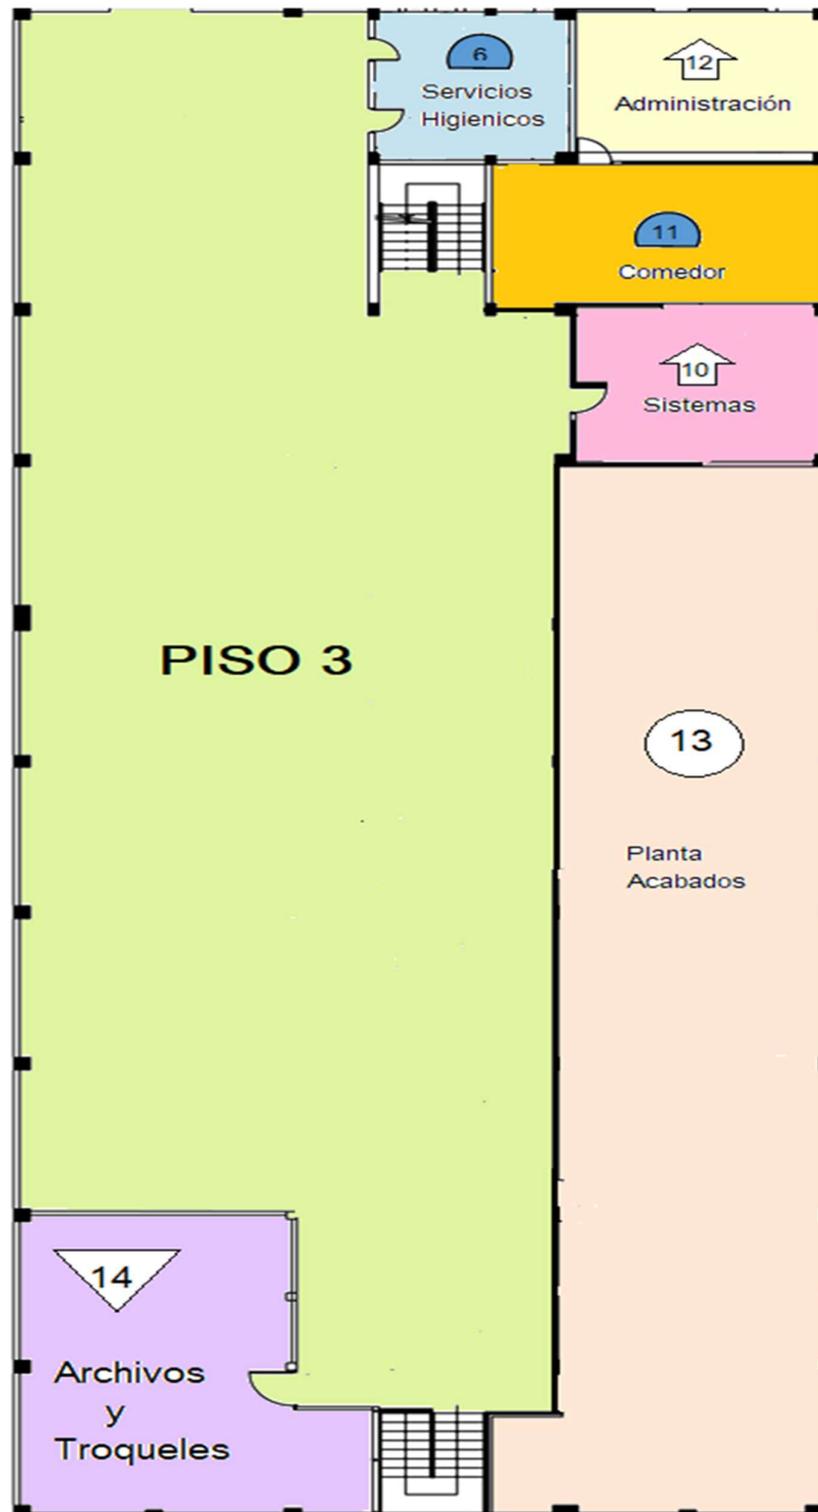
Propuesta de Distribución de Planta del tercer piso.
